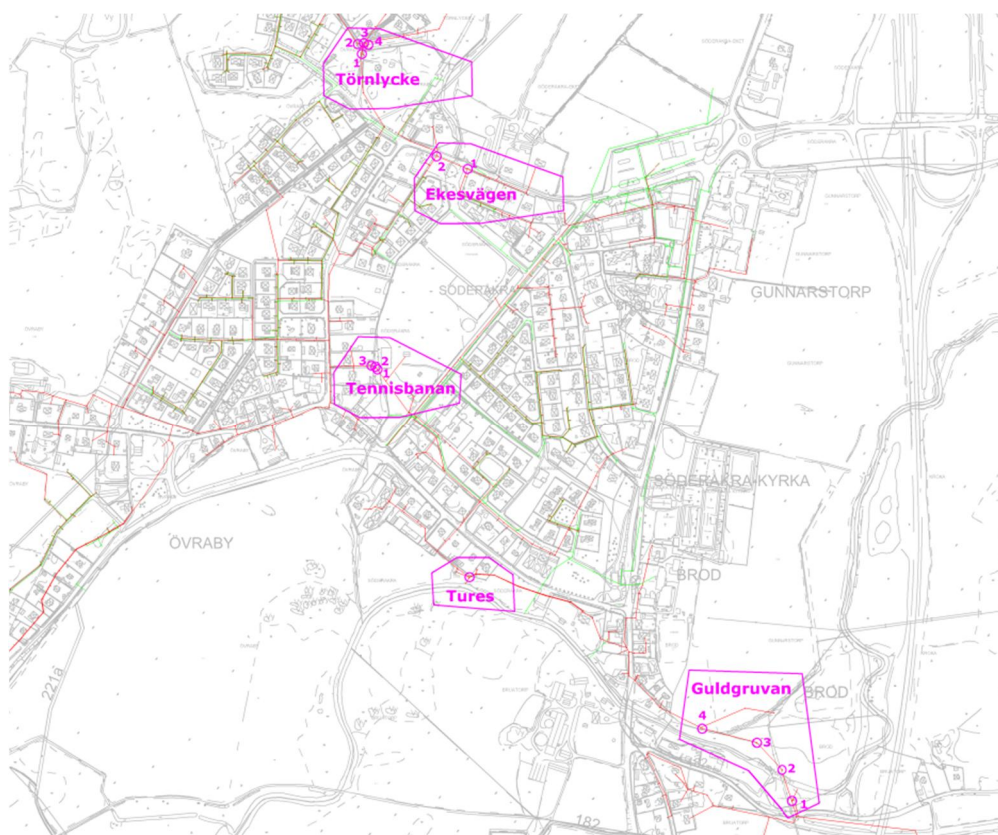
Plan – brunnar som bör besiktas okulärt med avseende på grundvatteninläckage, Bilaga 10
